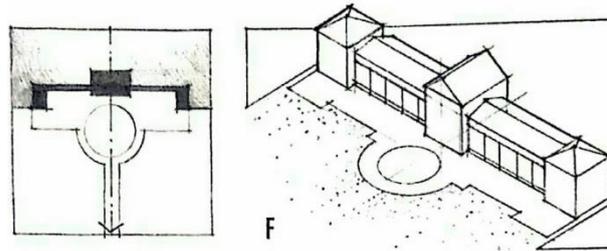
4 Sketsa dan Layout Ruang D
